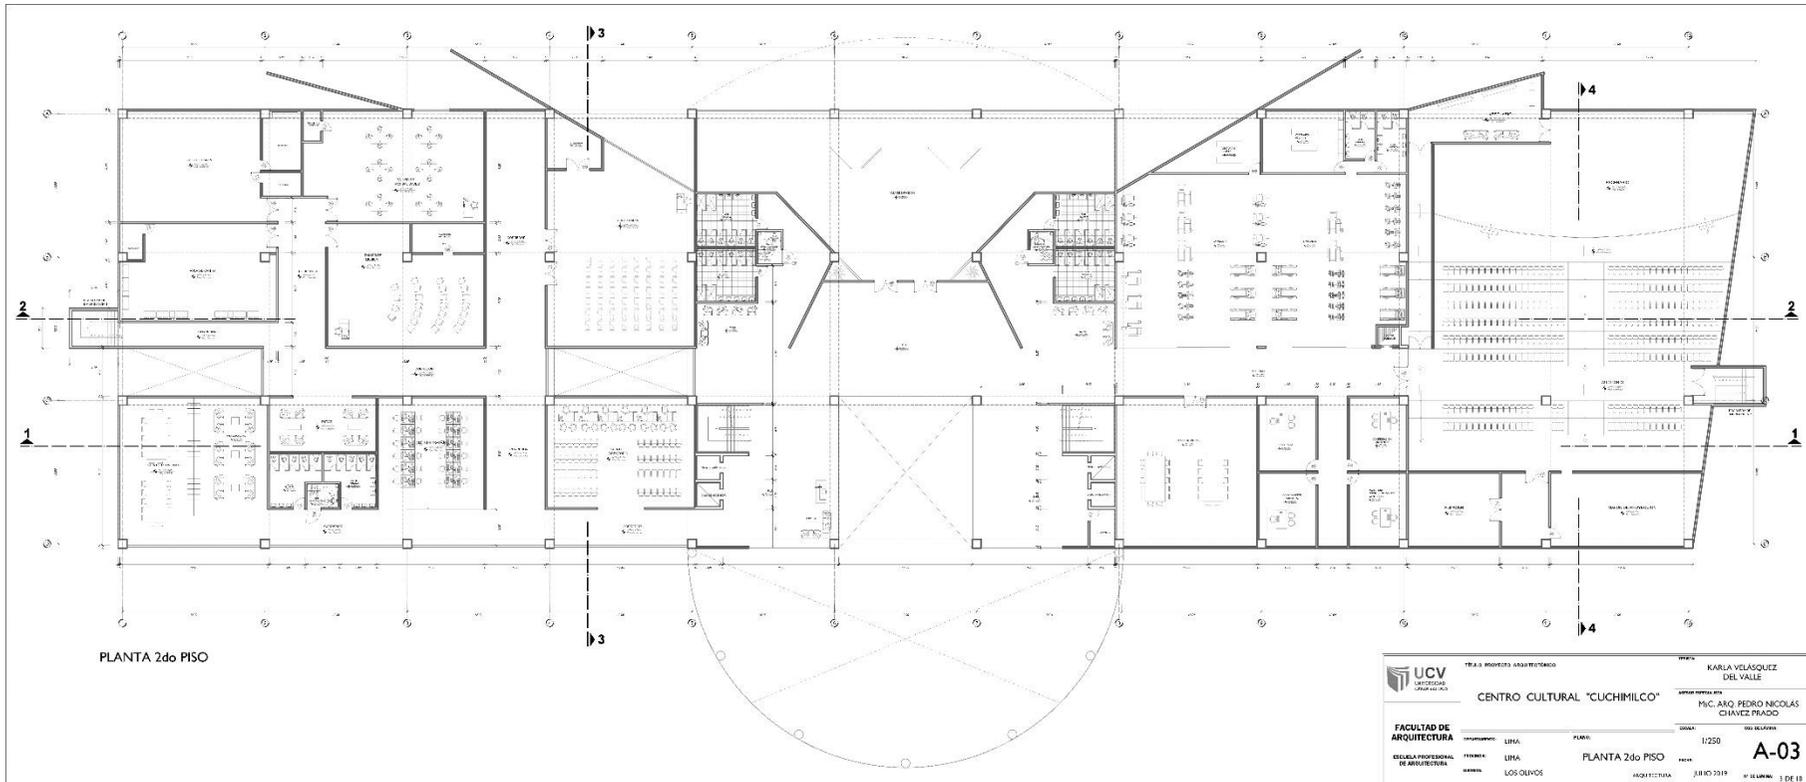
Plano de Arquitectura Planta 2do Piso. Elaboración propia
